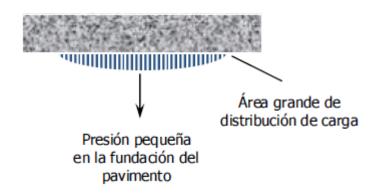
Distribución de esfuerzos de un Pavimento Rígido Fuente: Manual de procesos Constructivos para Pavimentos de baja intensidad del tráfico de el Salvador utilizando concreto hidráulico simple y emulsiones asfálticas.
